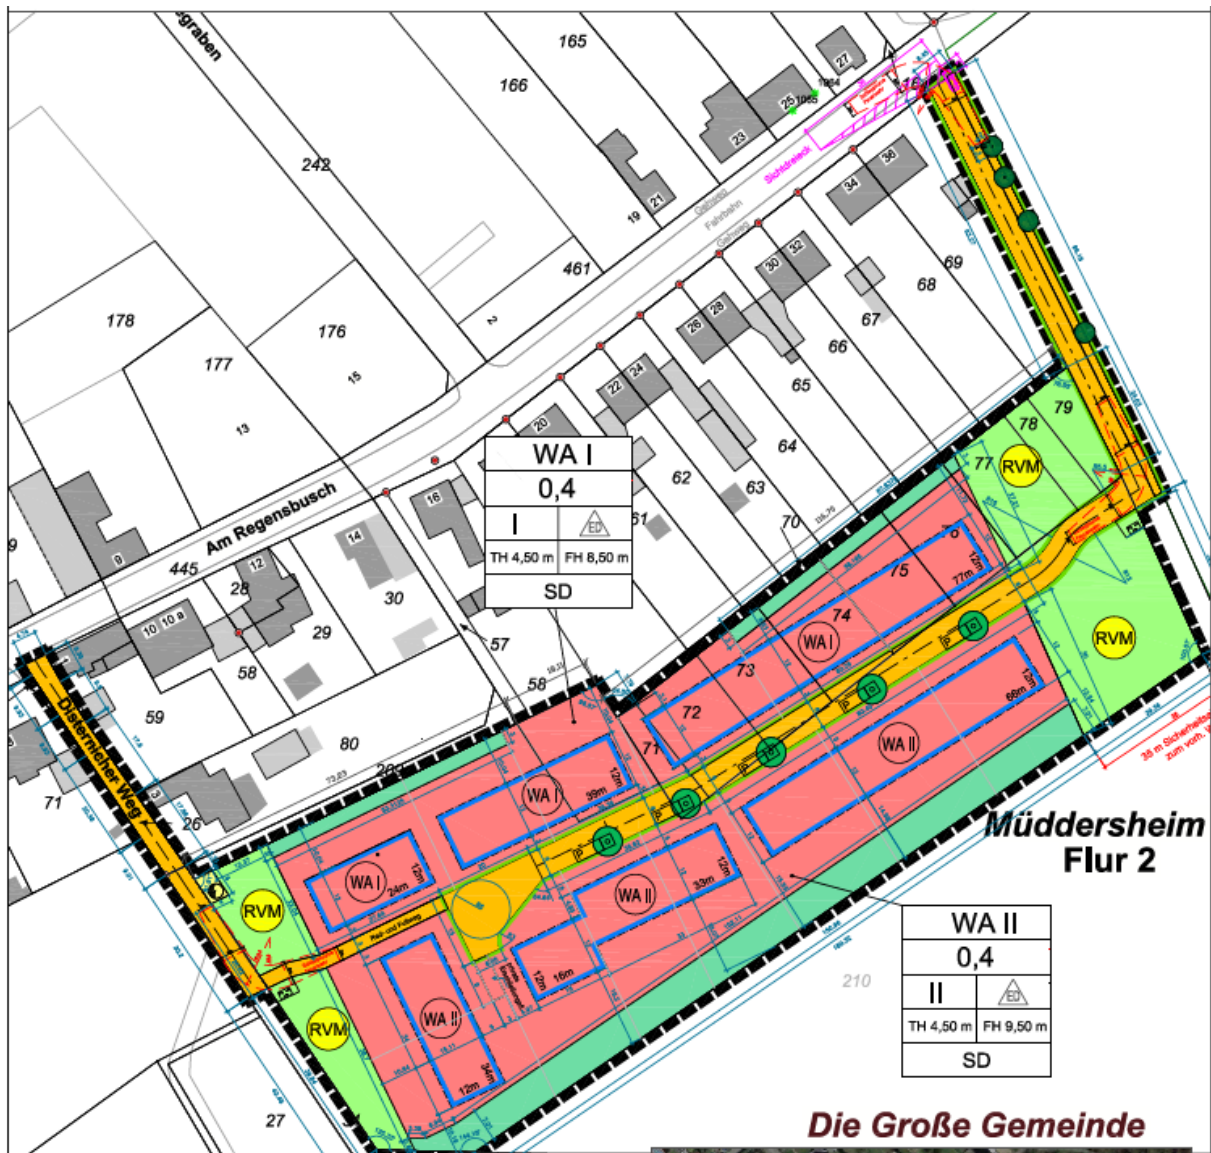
Lageplan des Plangebiets mit der geplanten Bebauung (ohne Maßstab)
